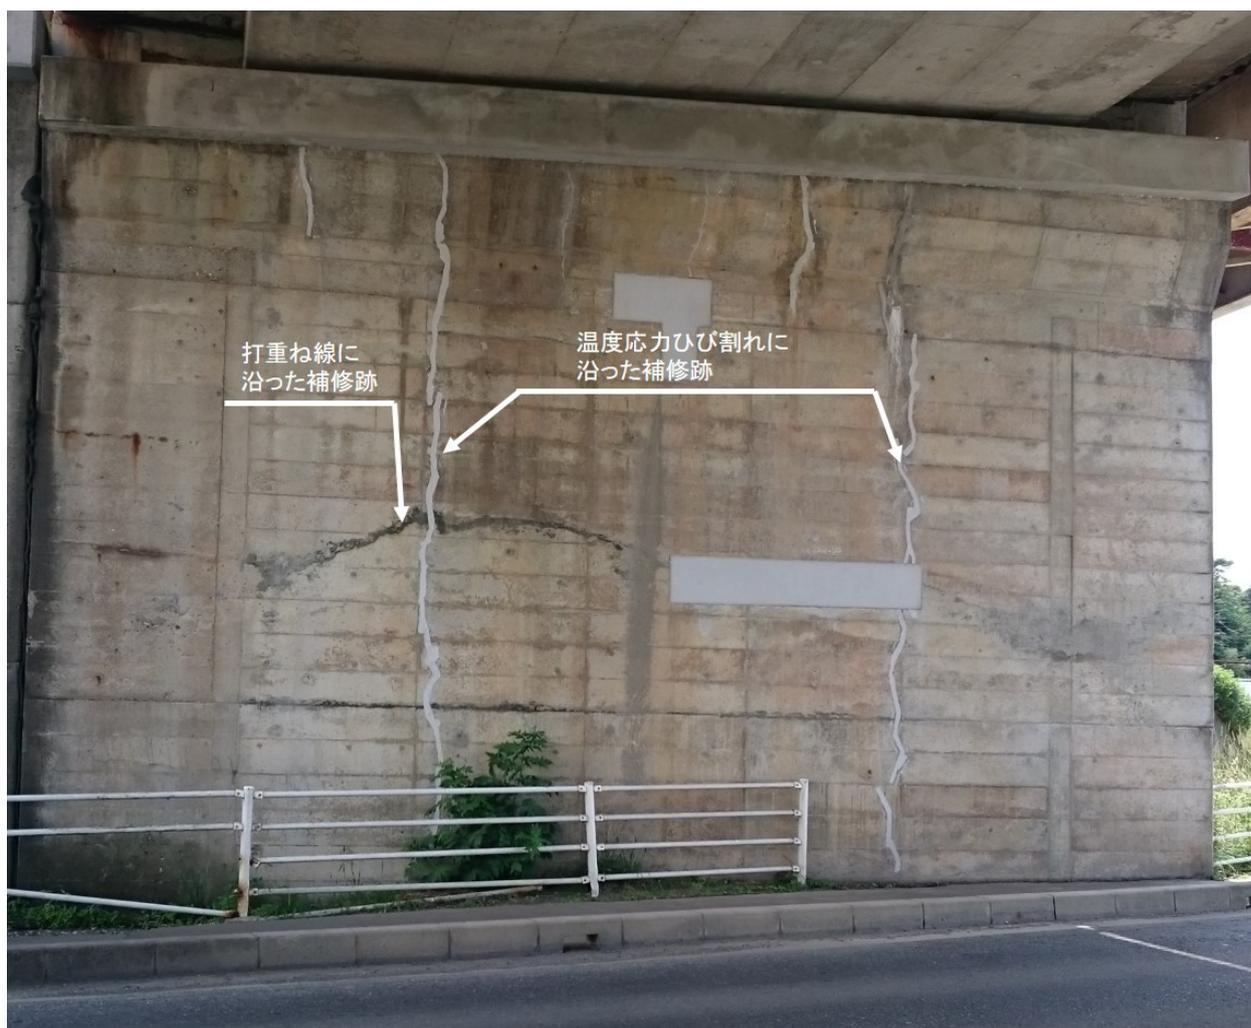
打重ね線や温度応力ひび割れ箇所の本来は不要だった補修跡
